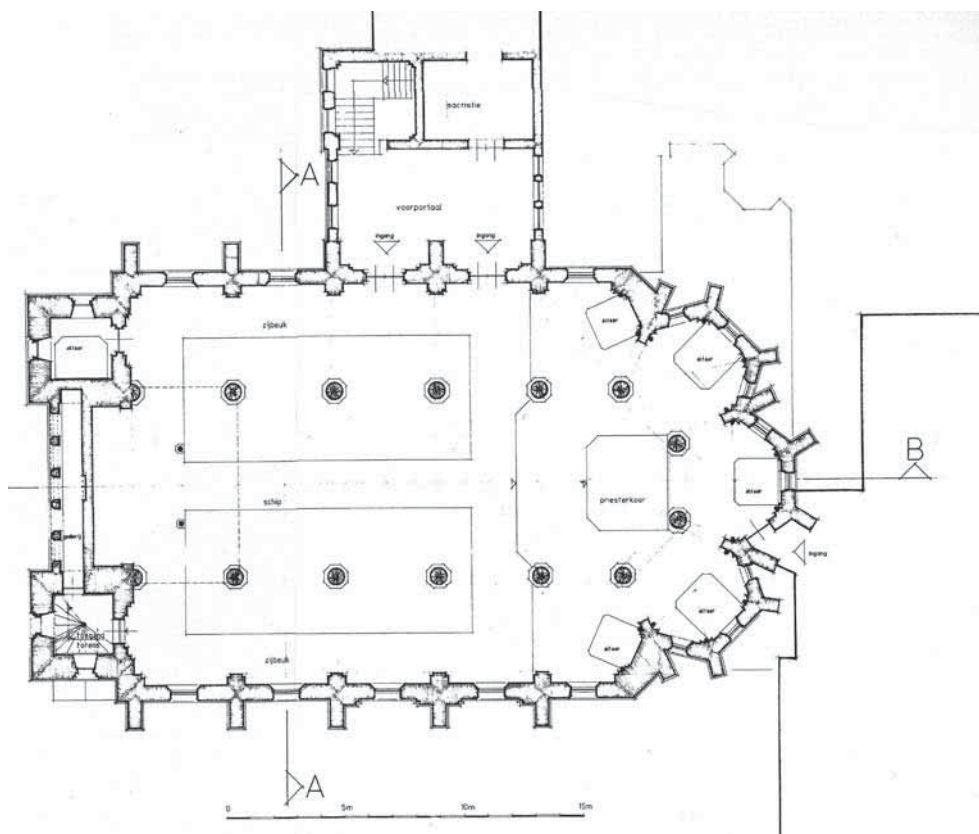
Grundriss Oberkerche, aufgenommen 1995 (Maßstab im Originalplan 1:100)
